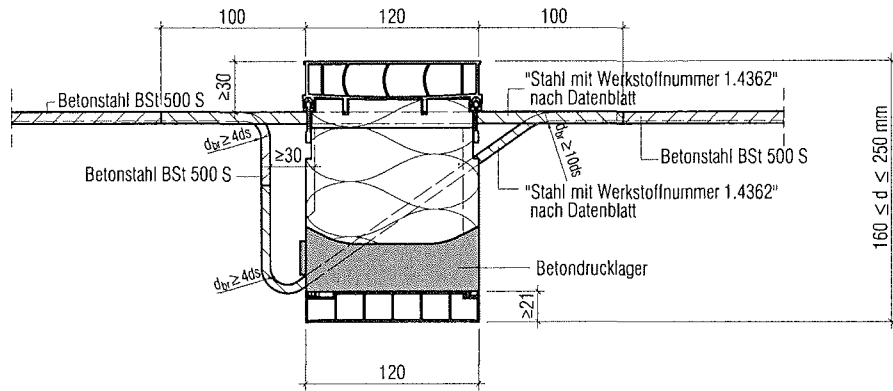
Schöck Isokorb Typ K mit Druck- Querkraft Kombination und integrierter Aufhängebewehrung
